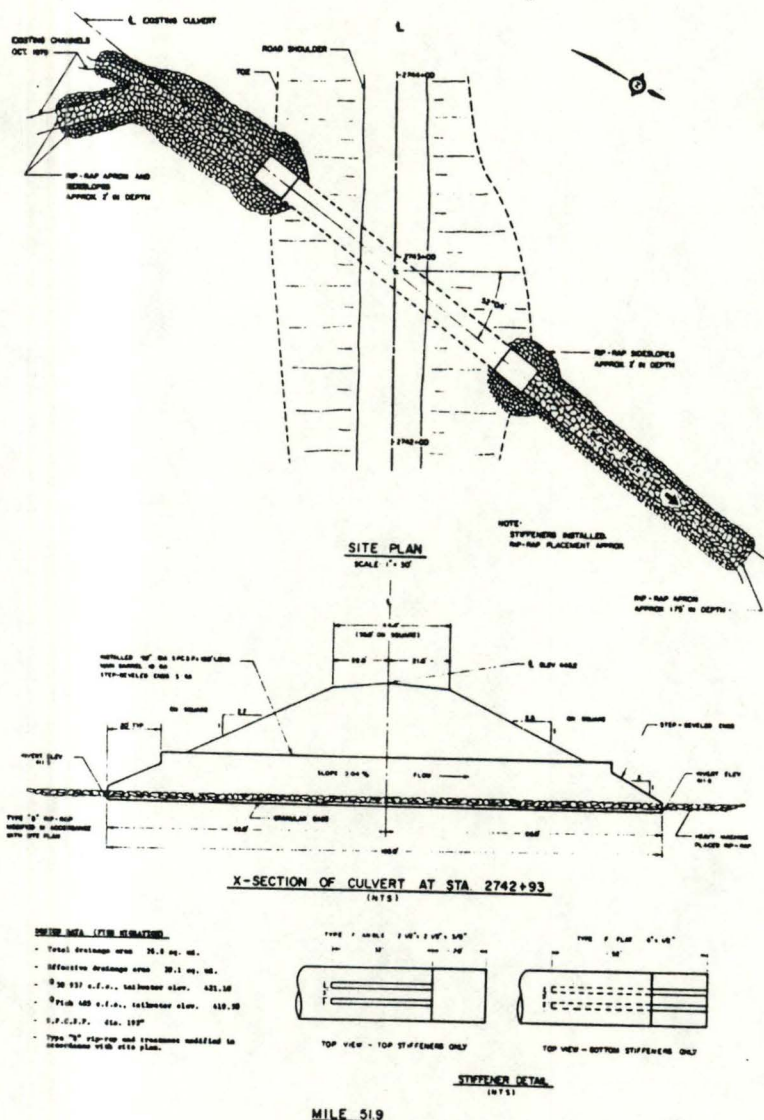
Plan du site d'installation d'un ponceau (d'après Mc KINNON et HNYTKA, 1985).
